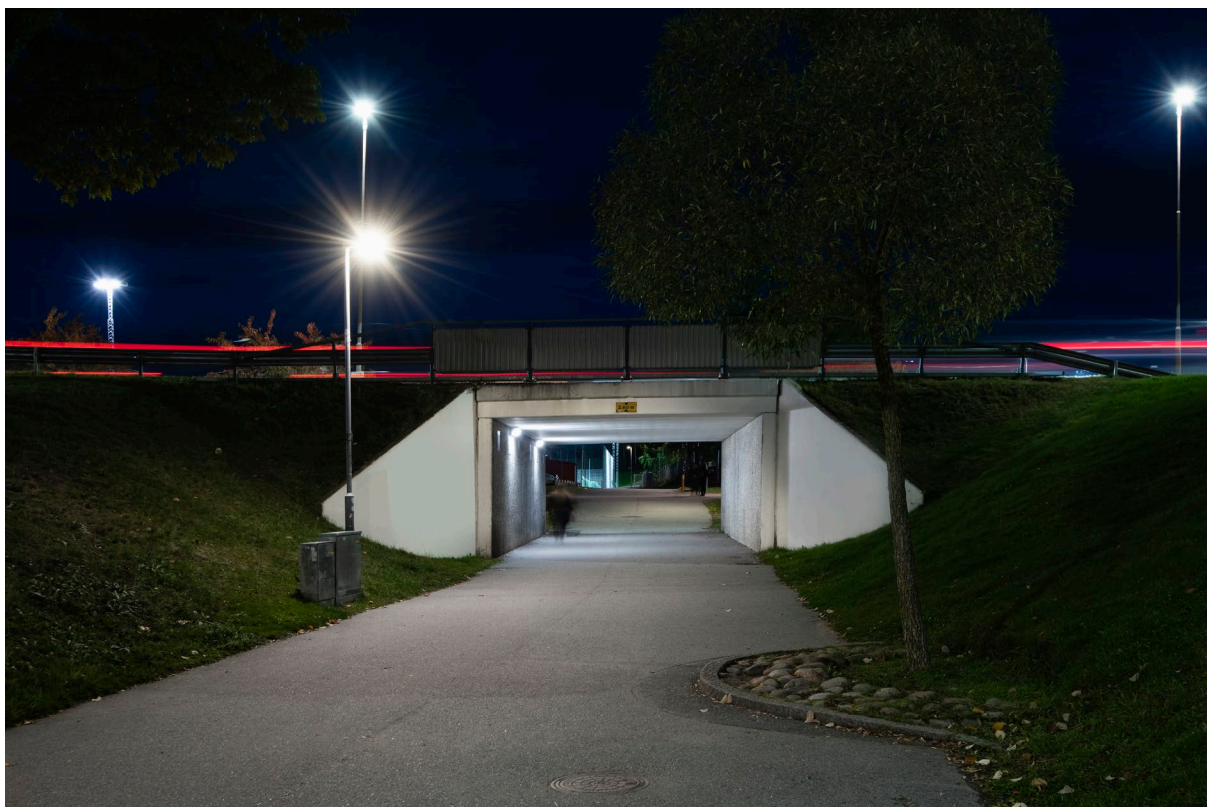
Gångtunnel mellan Vilundaparken och Väsby centrum.
